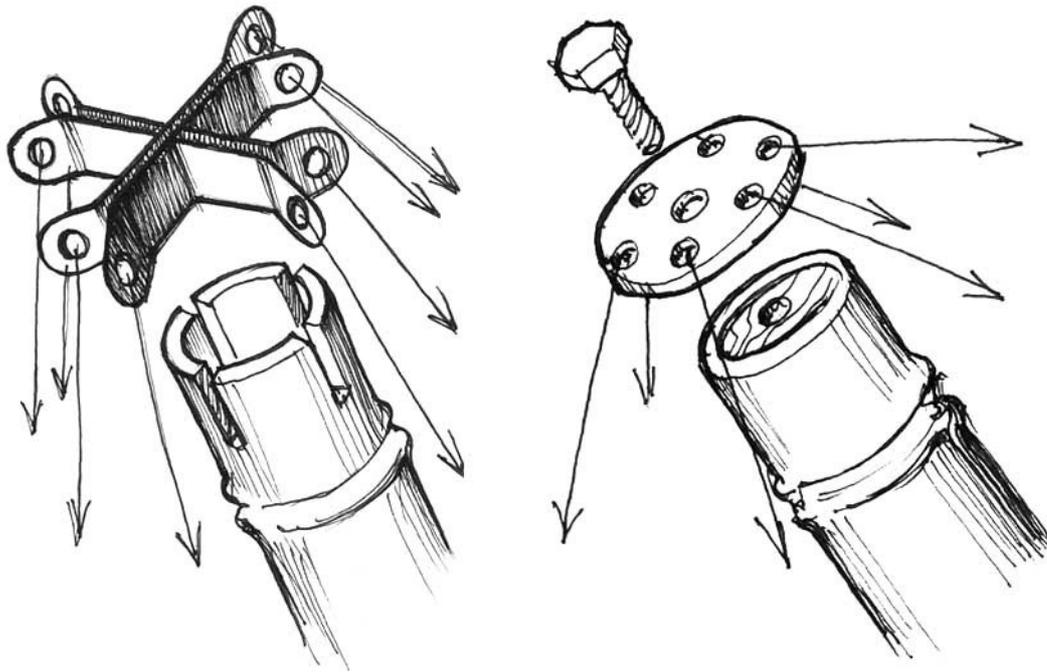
Fixador 9 - Idem Figura 51, com oito terminais. Fixador 10 - Disco metálico giratório com furações, aparafusado em bucha de madeira cravada no topo da haste. (desenhos do autor).
